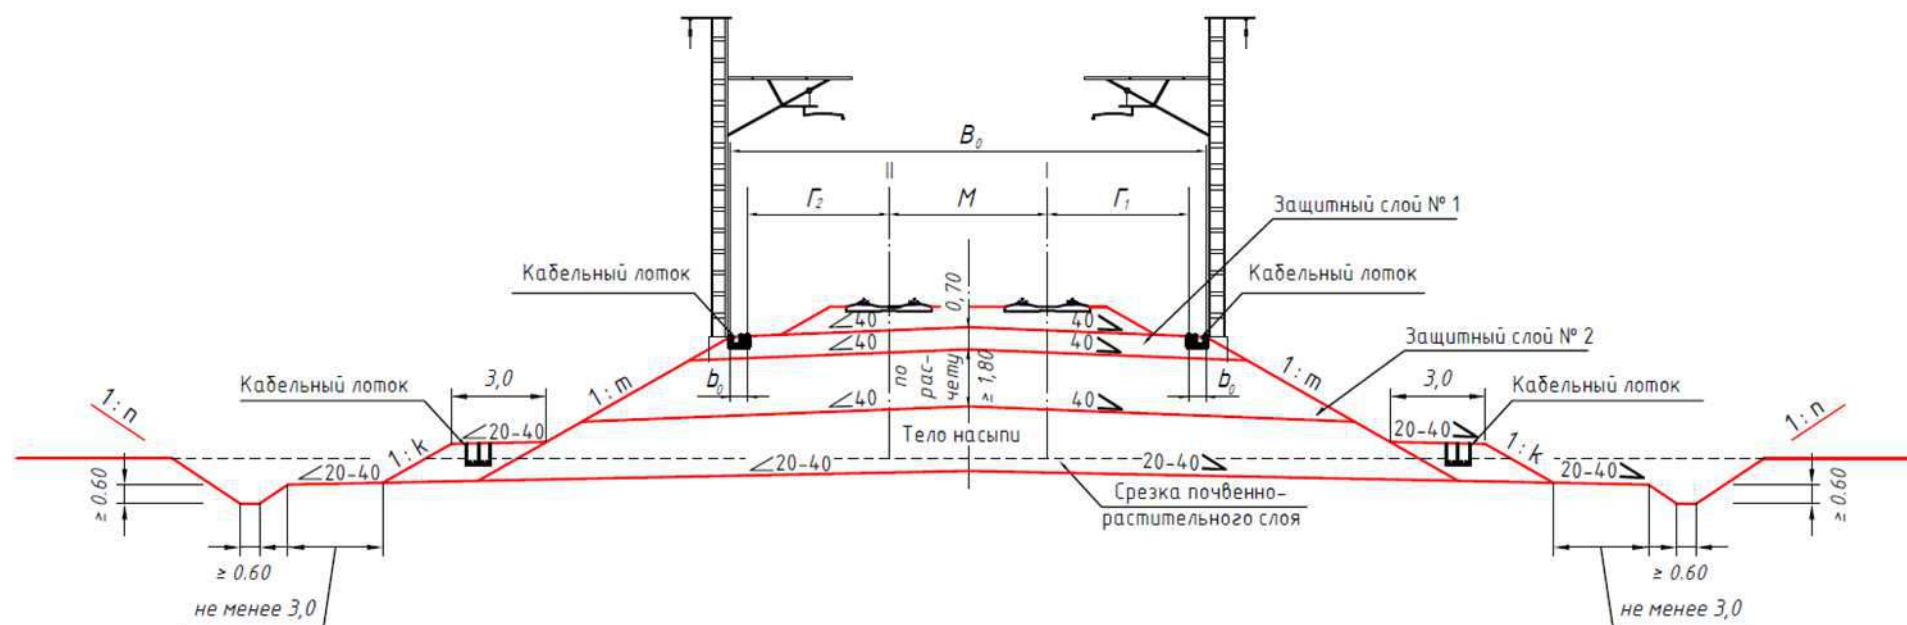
Конструкция насыпи на участке укладки верхнего строения пути с ездой на балласте
